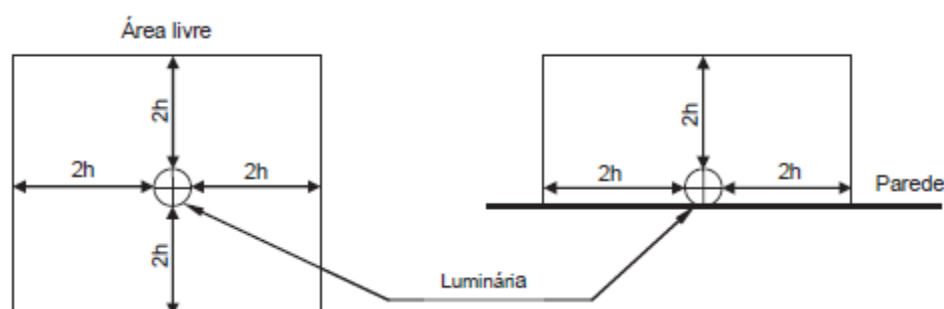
Indicação de instalação dos pontos de iluminação em tetos ou paredes. Fonte: NBR 10898/2013
